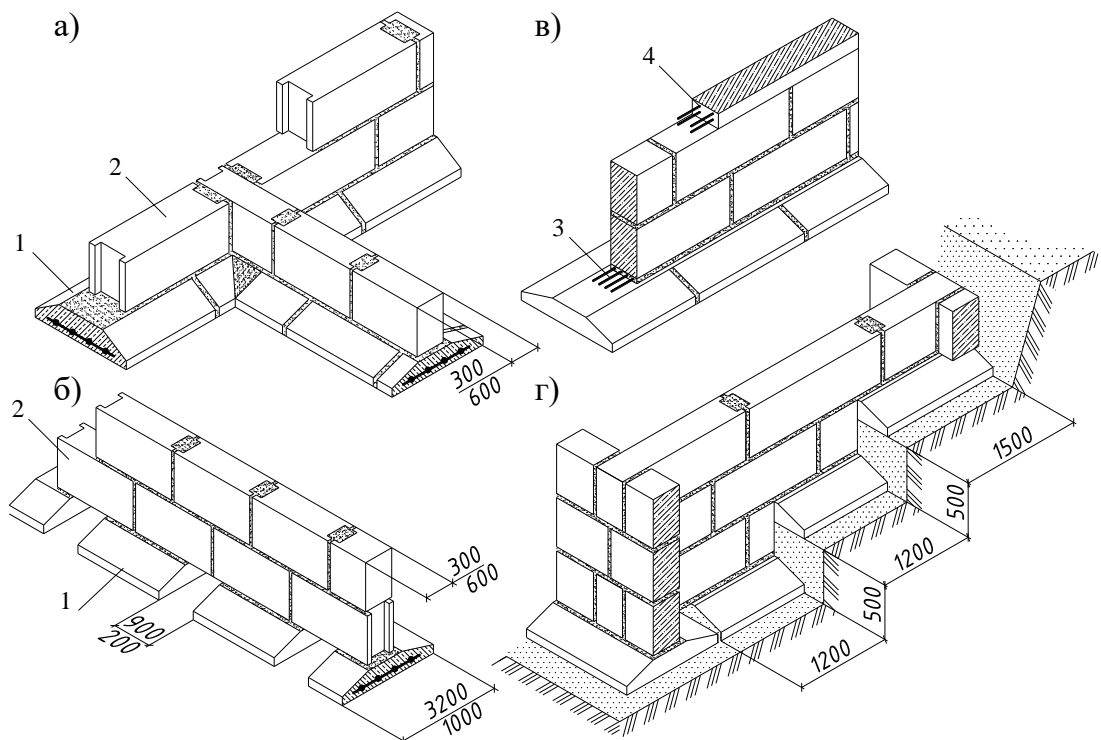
Збірний блоковий стрічковий фундамент із збірних плит і стінових блоків: а – суцільний фундамент; улаштування примикання фундаменту внутрішньої стіни до зовнішньої; б – переривчастий фундамент; в – фундамент із з/б поясом та армованими швами на нерівномірно ущільнюваних основах; г – на косогорах і при переході від підвальної частини до безпідвальної; 1 – фундаментні плити; 2 – стінові блоки; 3 – армований шов товщиною 30 – 50 мм; 4 – армований пояс товщиною 100 – 150 мм
